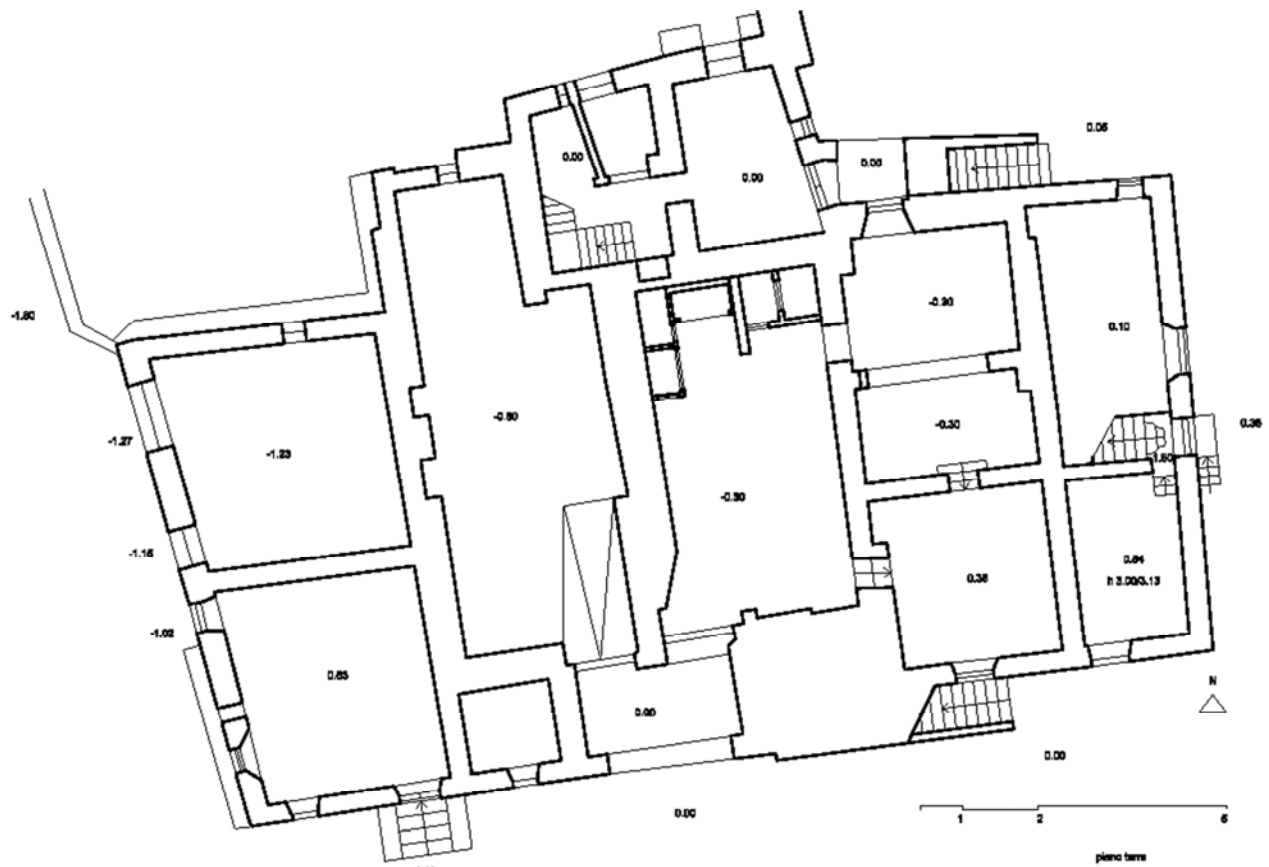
Planimetria del piano terra. Scala 1:200
